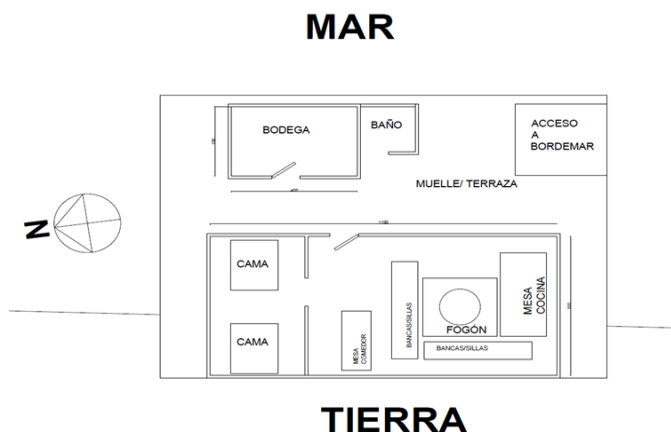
Esquema de planta de palafito [Elaboración propia]
